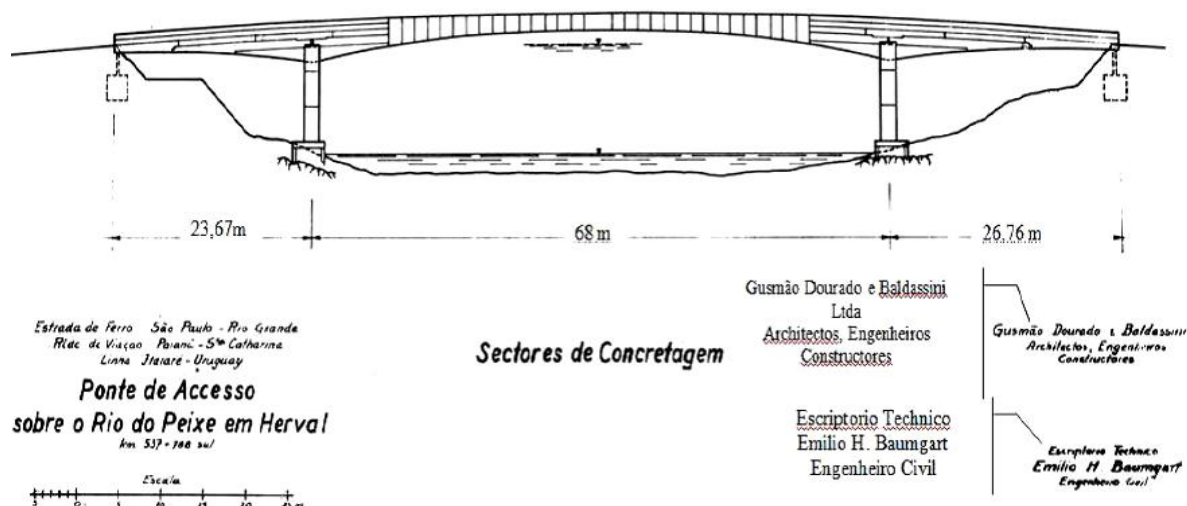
Divisão da viga em setores de concretagem, a fim de facilitar a sua original construção.
